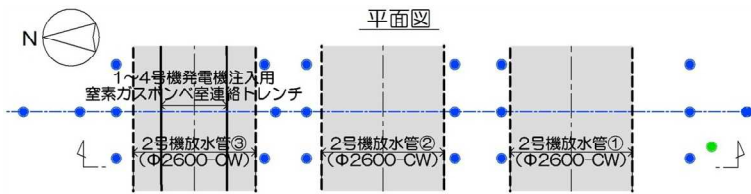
【11-13】No.2 軽油配管トレンチ 施工方法（貫通施工）
